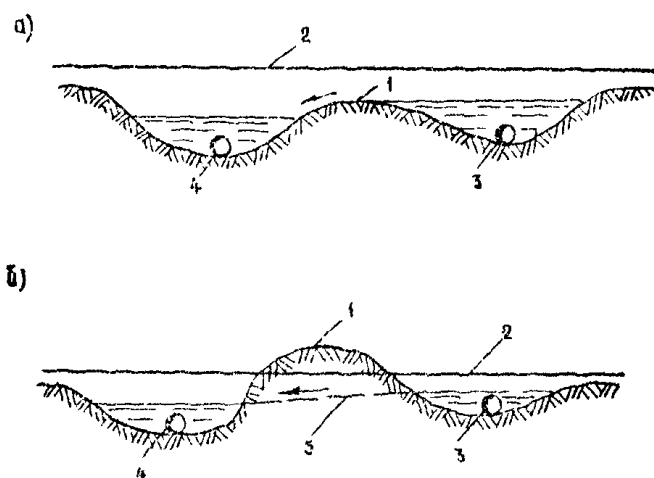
Схемы к расчету искусственного распределения максимального стока: 1-водораздел; 2-проектная линия продольного профиля дороги; 3-верховое водопропускное сооружение; 4-низовое сооружение; 5-сбросной лоток.
